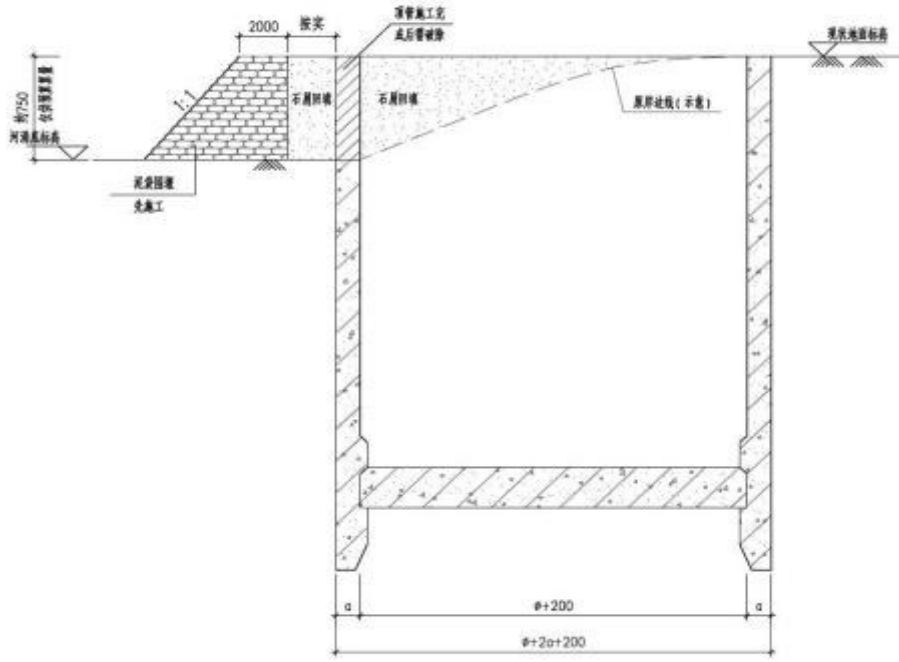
涌（池）边顶管井施工平台剖面图
